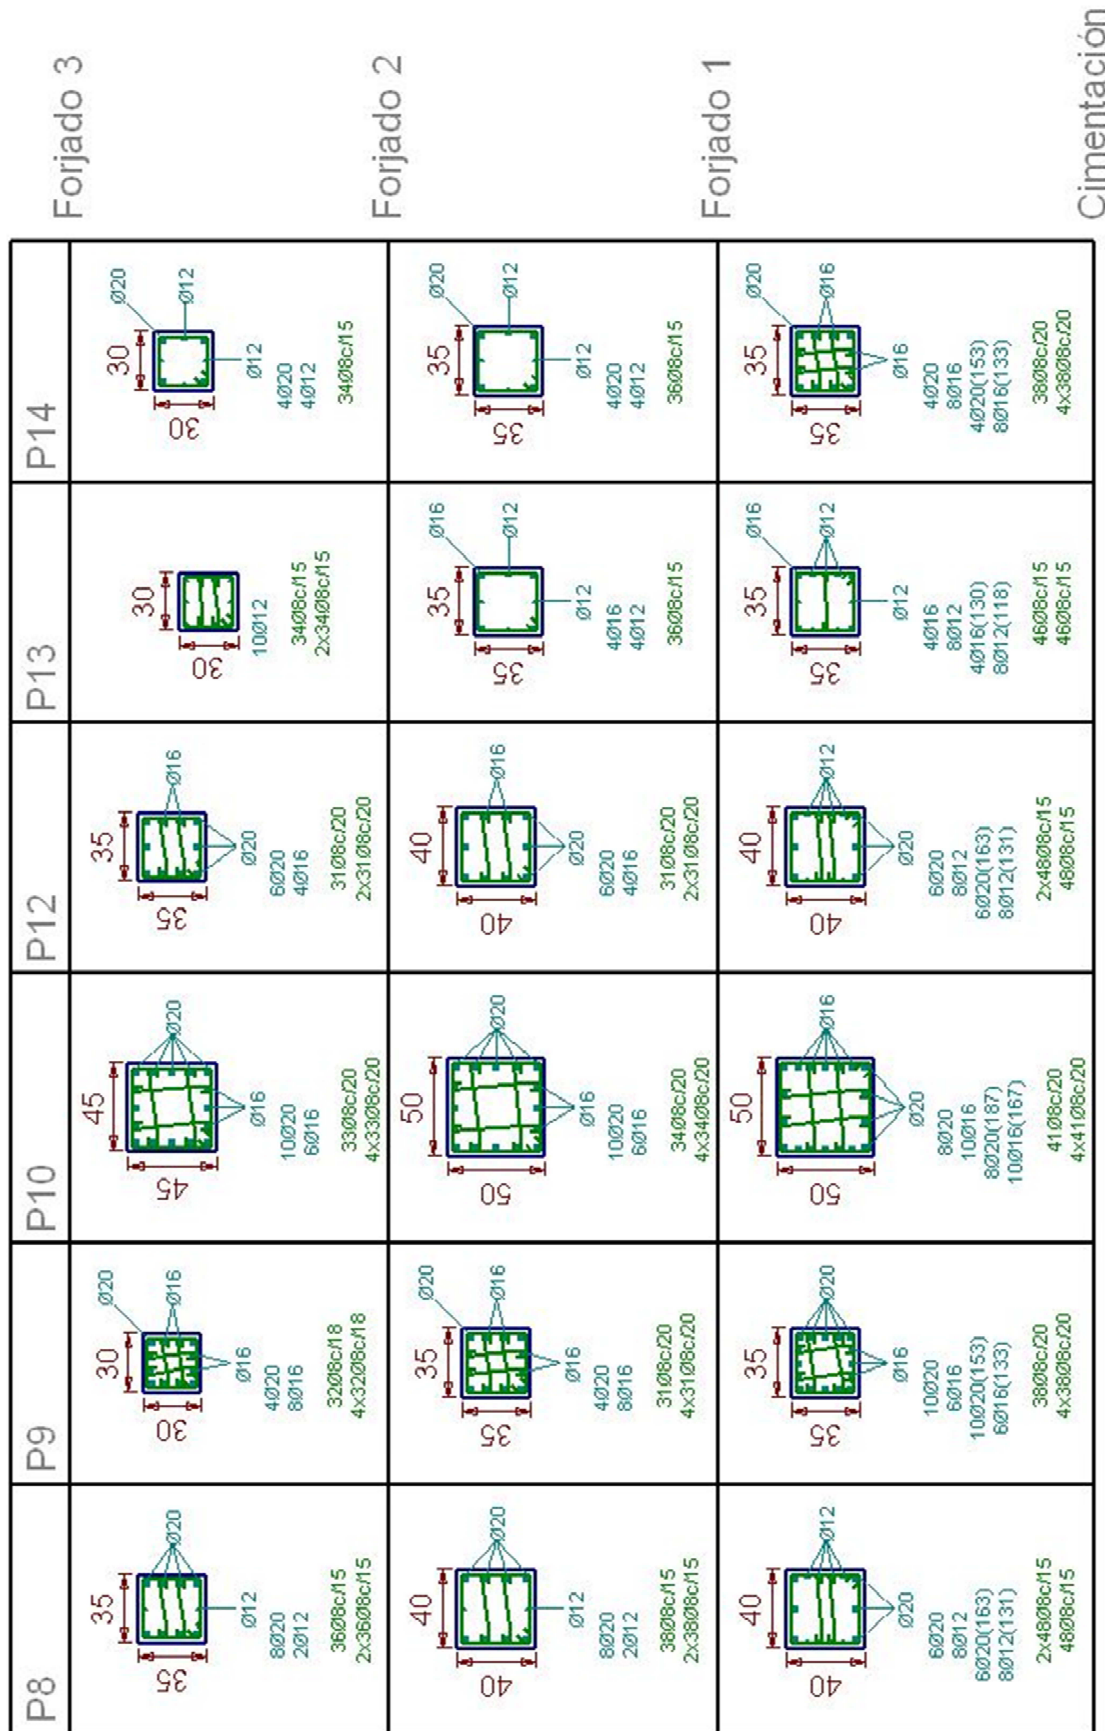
Armadura en pilares (5). Edificio de 9 plantas (SISMO + G).
